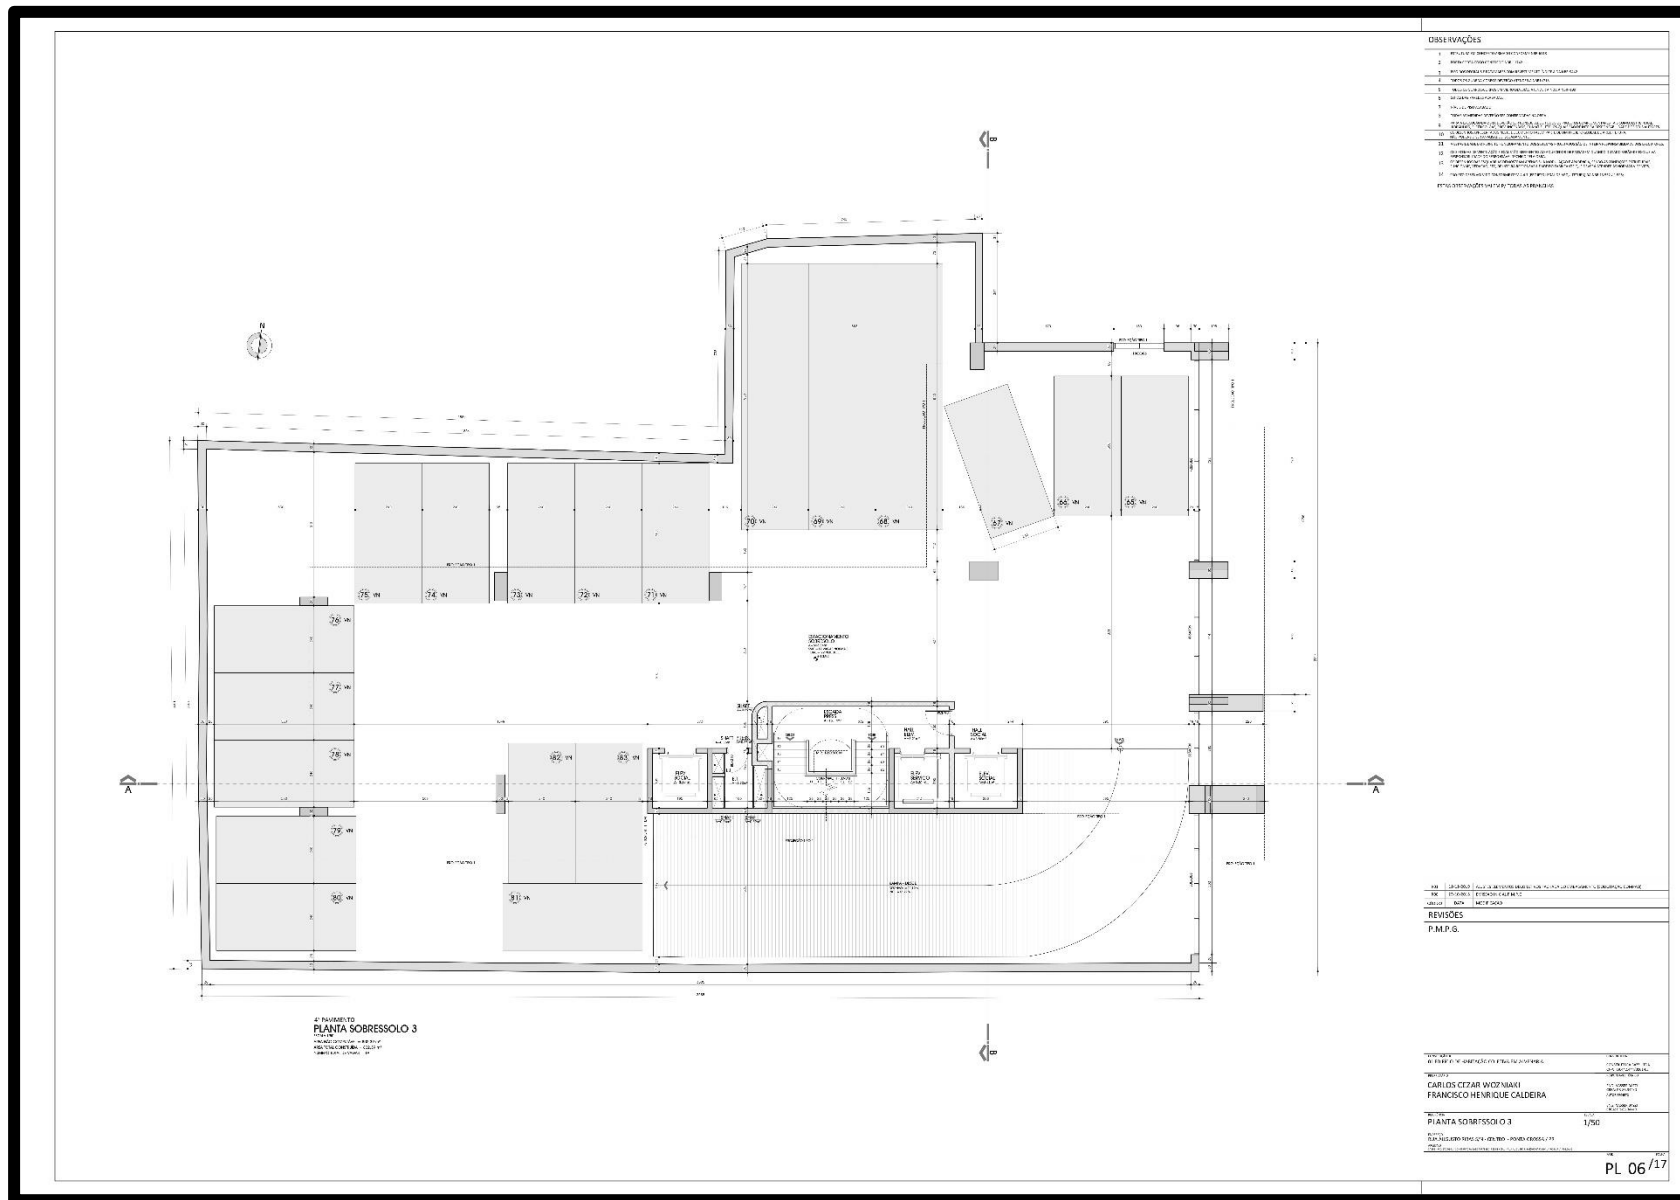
Planta pavimento sobressolo 3. Fonte: Construtora Bazzi (2020).
